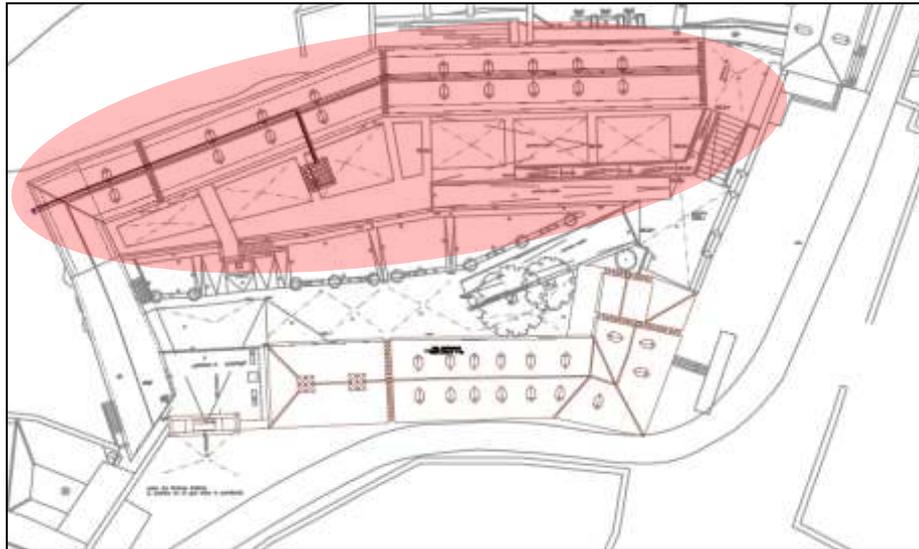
Planta de ubicación del sistema de drenaje y tanque de tormentas existente.
